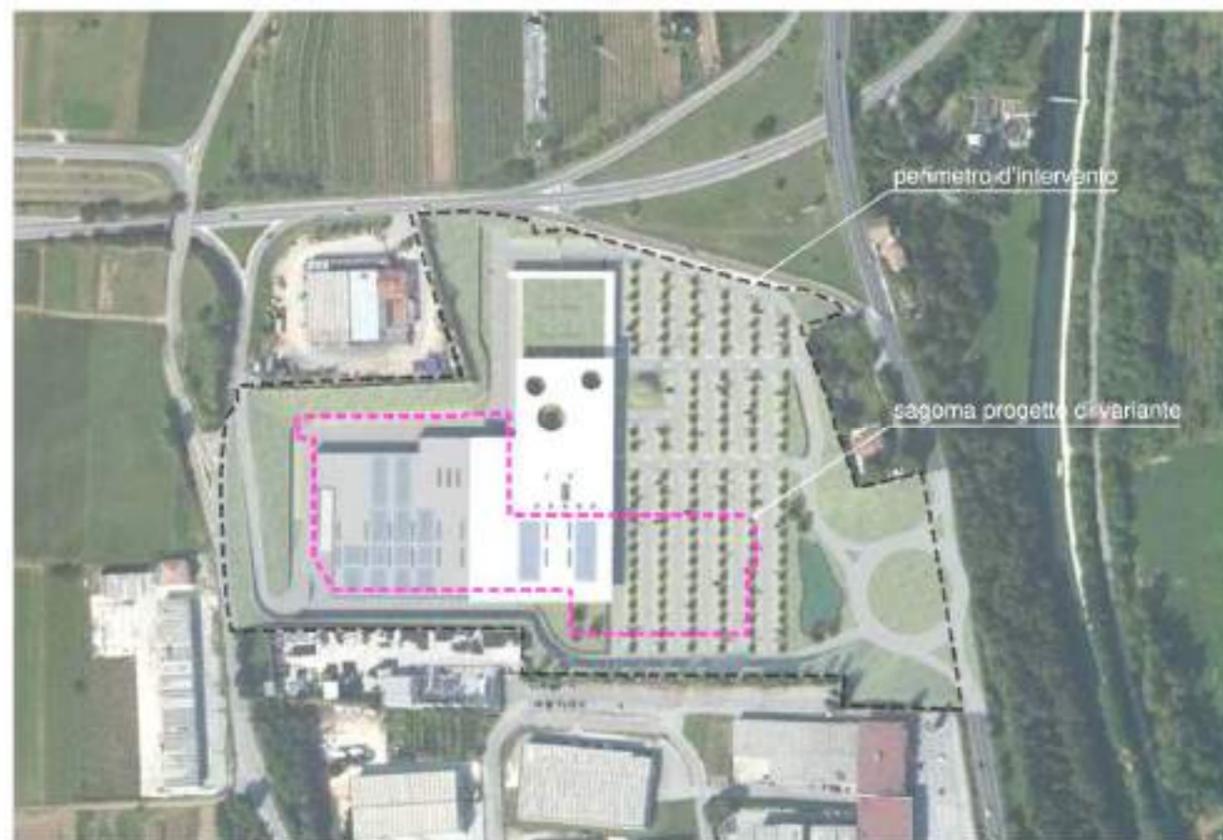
Sovrapposizione progetto di variante sul progetto originario
